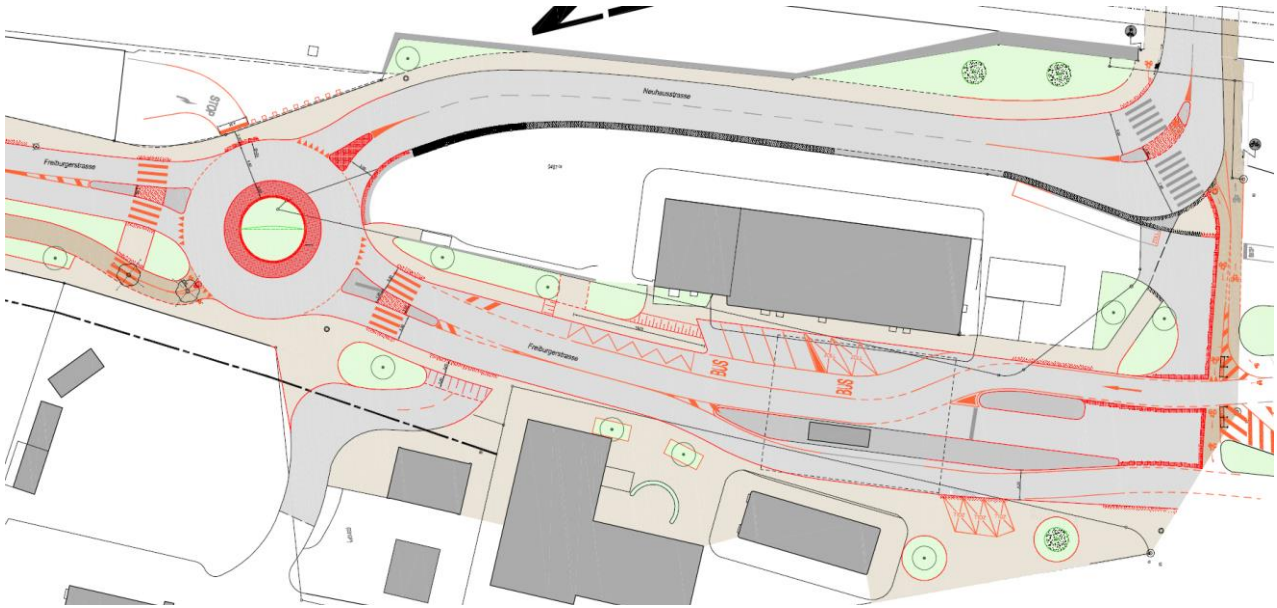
; Projekt – Planausschnitt, Abschnitt C
